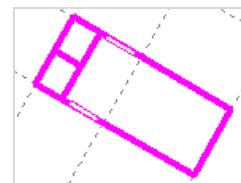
Отверстия в стенах (фрагмент плана)
